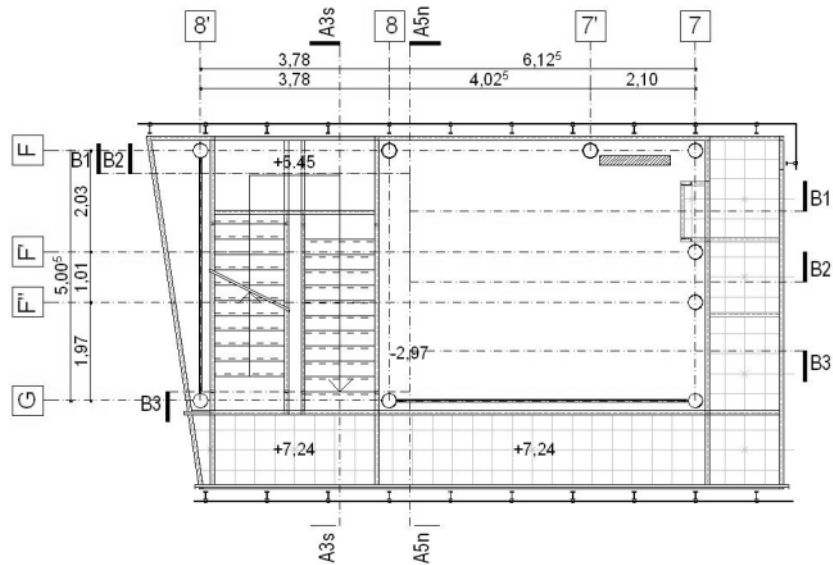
Hol 'atrium' - plan PARTER; plan DEMISOL
